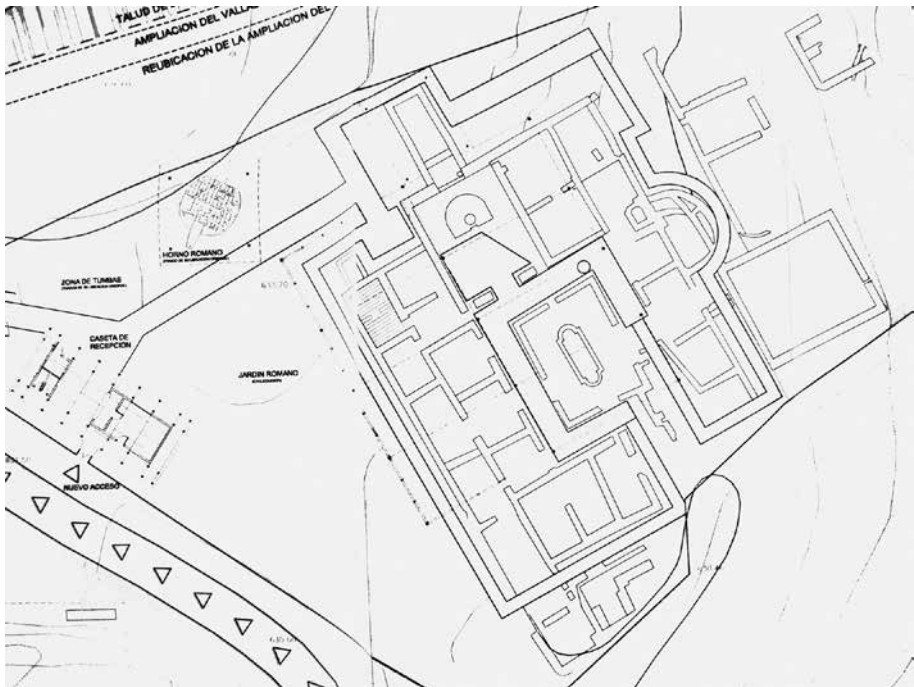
Planta general. Plano sin escala. Arquitecto Marian Martínez
